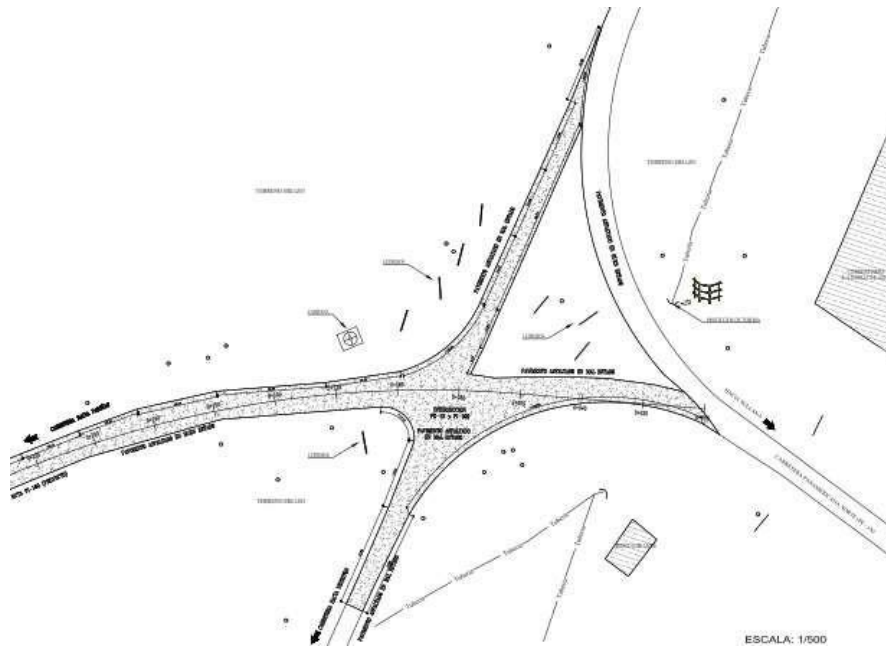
Plano de planta existente de la intersección “La Campana”, Talara, Piura.
